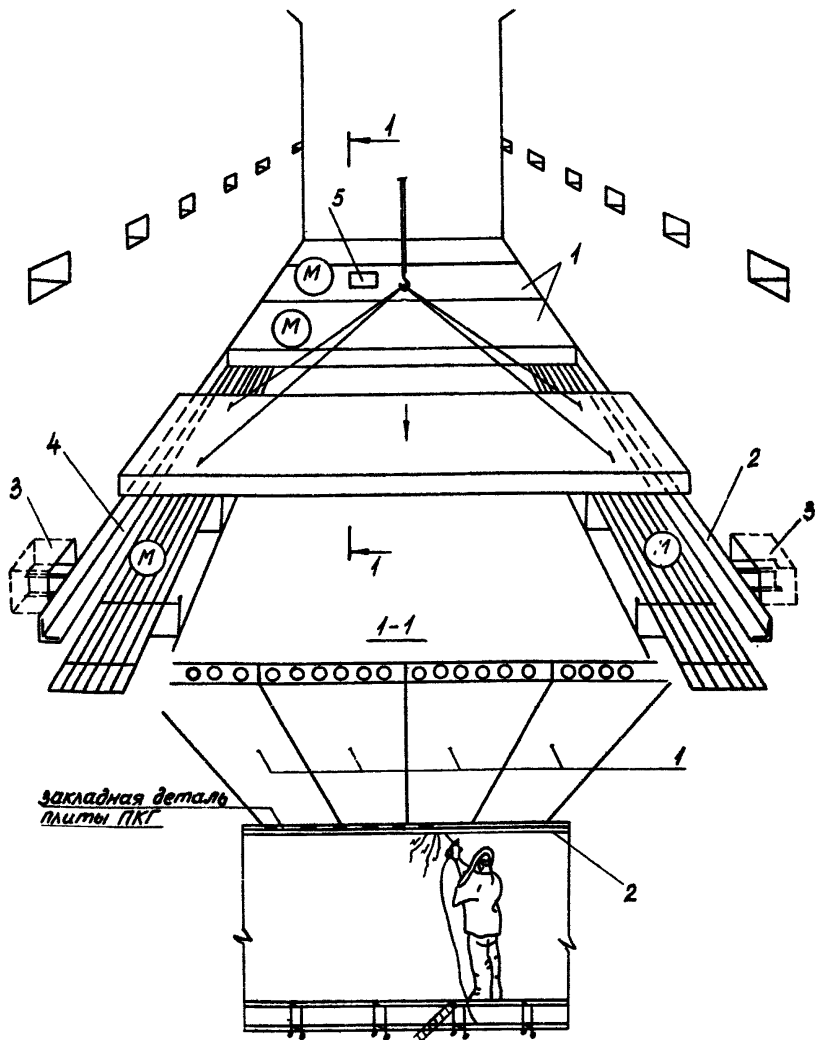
Общая схема организации работ по устройству участка перекрытия из плит ПКГ с опиранием на опорные гребенки МГО-17
